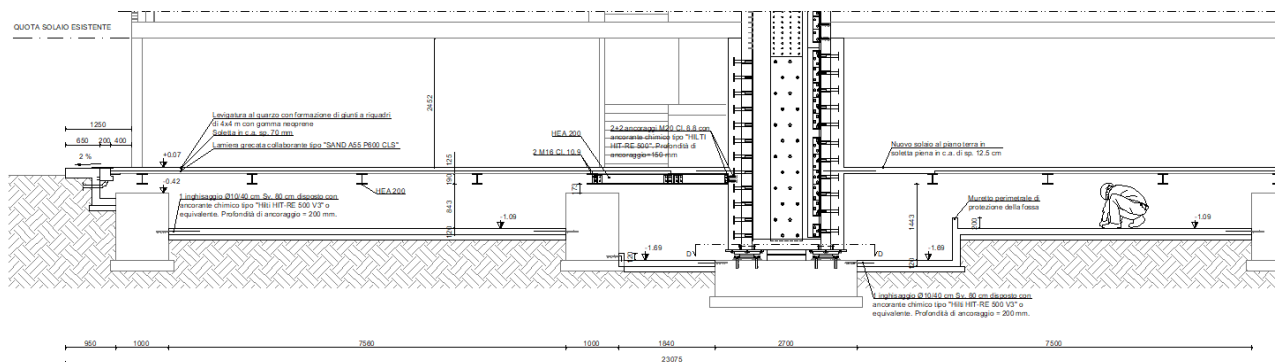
Realizzazione del nuovo solaio al piano terra e rinforzo dei vani ascensore
